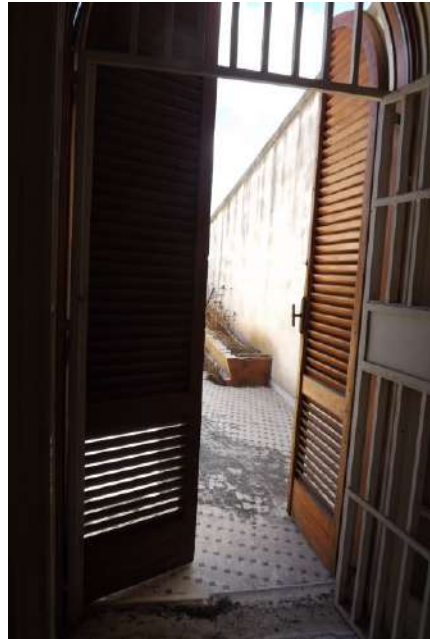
Vista d’insieme della originaria veranda, oggi chiusa con infissi e tamponamenti e trasformata, senza titolo edilizio, in vano abitabile.
